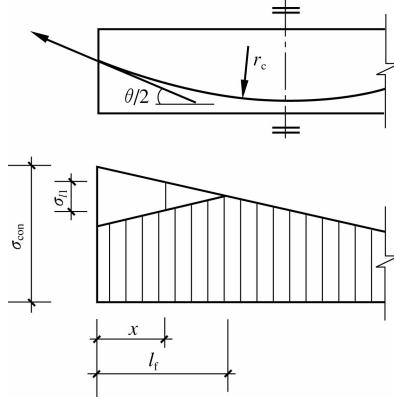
圆弧形曲线预应力钢筋的预应力损失 σ_{l1}
